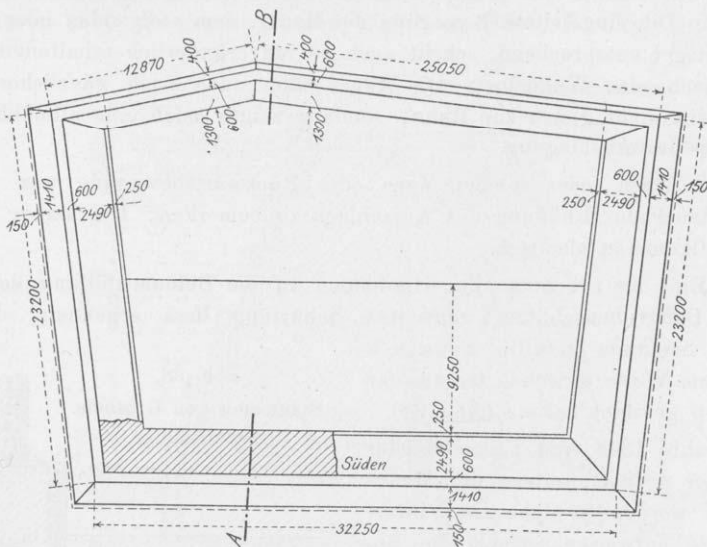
Reservoir von Sonzier. Grundriss.
